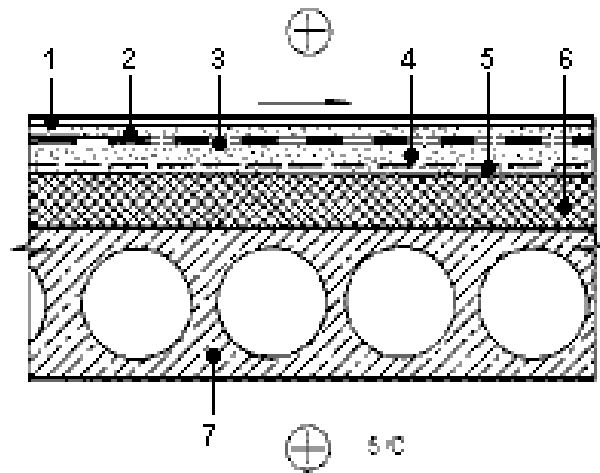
Пол над не утепленим підвалом при вологому режимі експлуатації (PAROC) : 1 - покриття підлоги; 2 - проміжна підлога; 3 - гідроізоляція; 4 - вирівнюючий шар; 5 - арматурна мережа; 6 - теплоізоляція; 7 - плита перекриття
